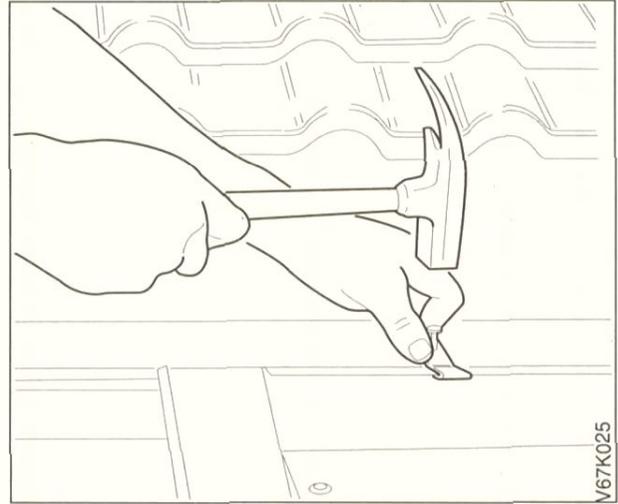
Obere Abschlussbleche am Rand zu den Ziegeln mit zwei Befestigungshaften pro Blech auf der Dachlatte fixieren.
